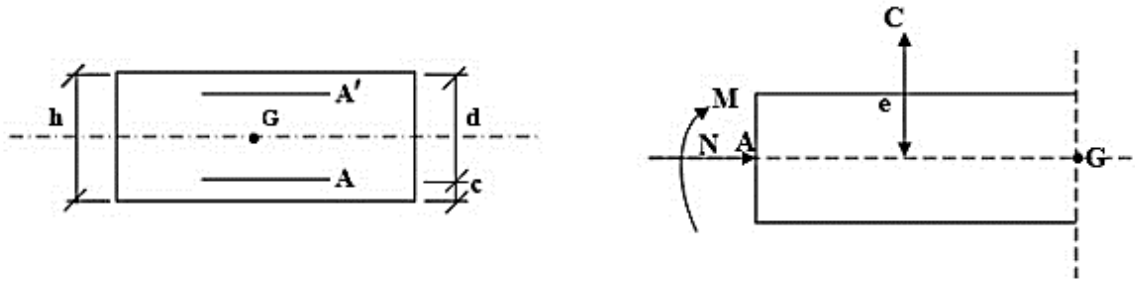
Schéma statique de la section de l’acrotère.
